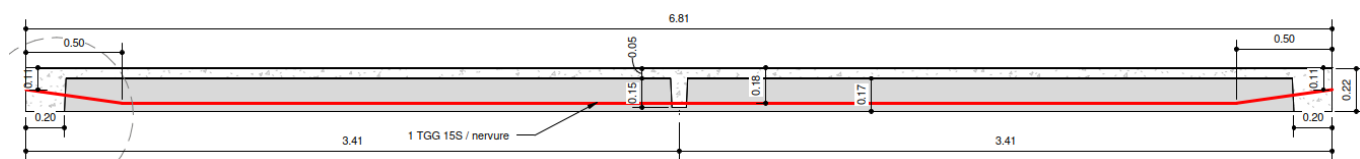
Coupe longitudinale d'un platelage de type 1 (courant) et tracé des câbles – Extrait du cahier de plans PRO
